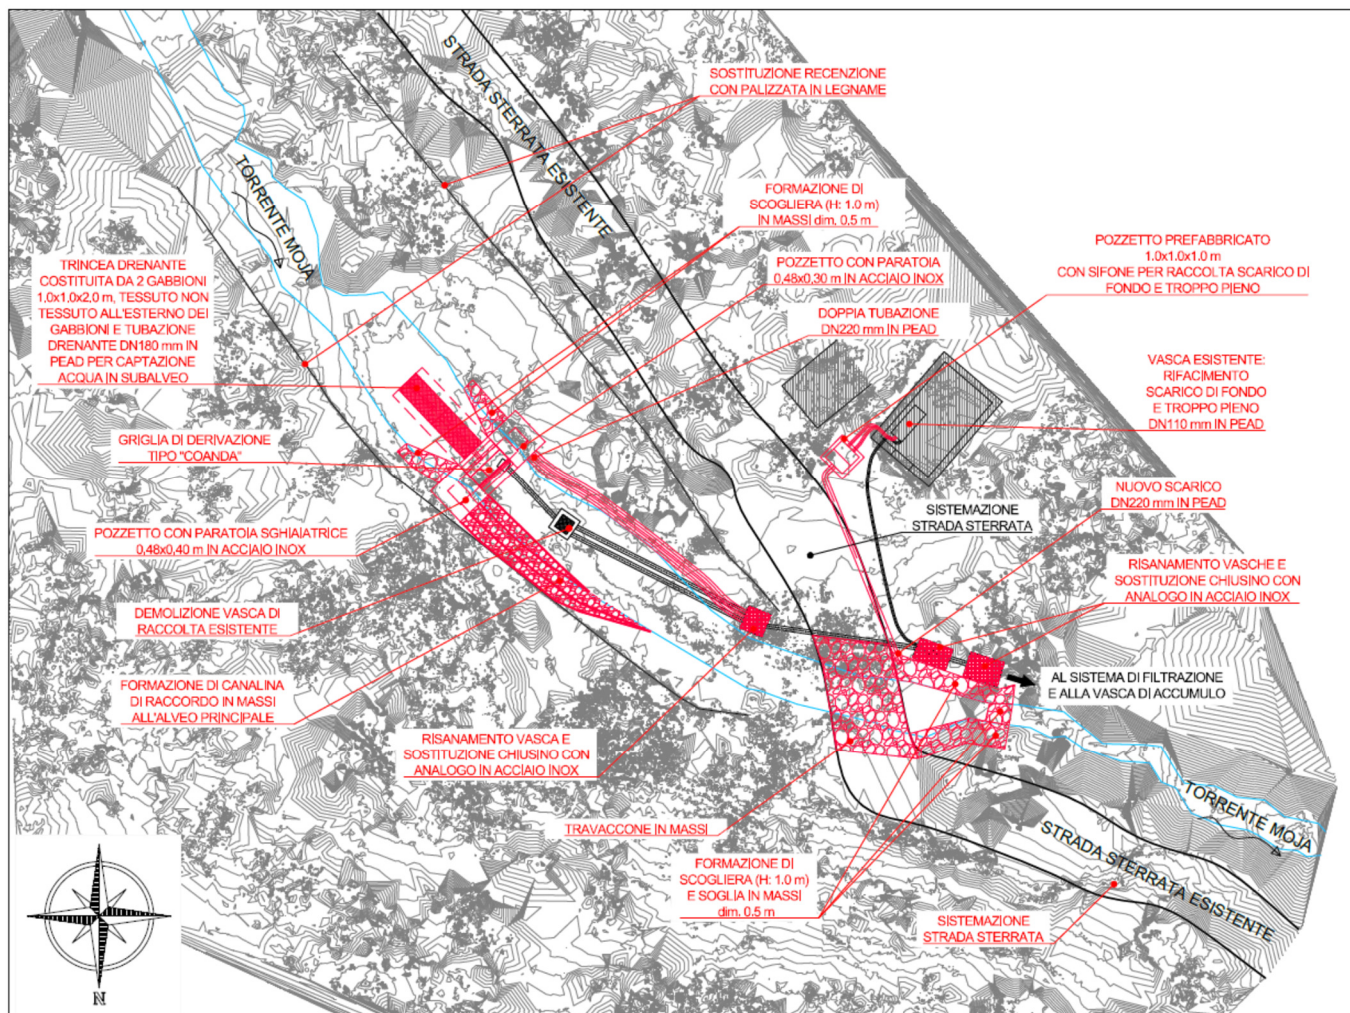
Planimetria dell'intervento in previsione (rio Moja)
